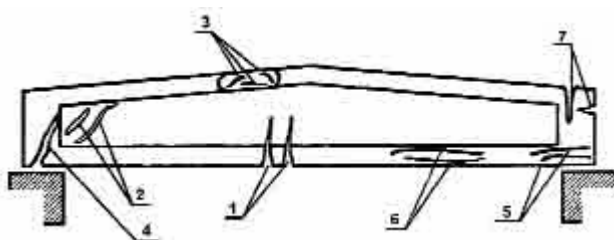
Картина трещинообразования в предварительно-напряженной стропильной балке.
